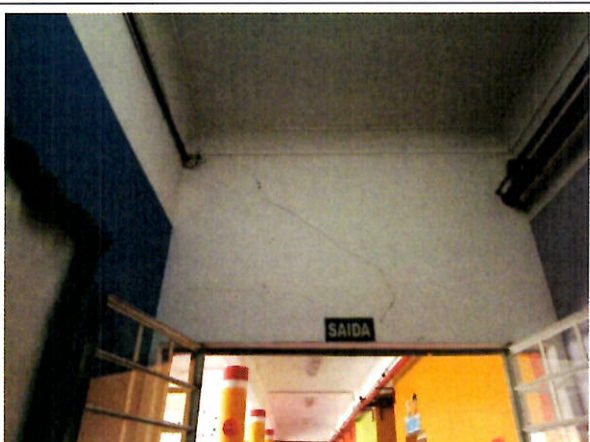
Fissura observada no hall de circulação no pavimento térreo.
